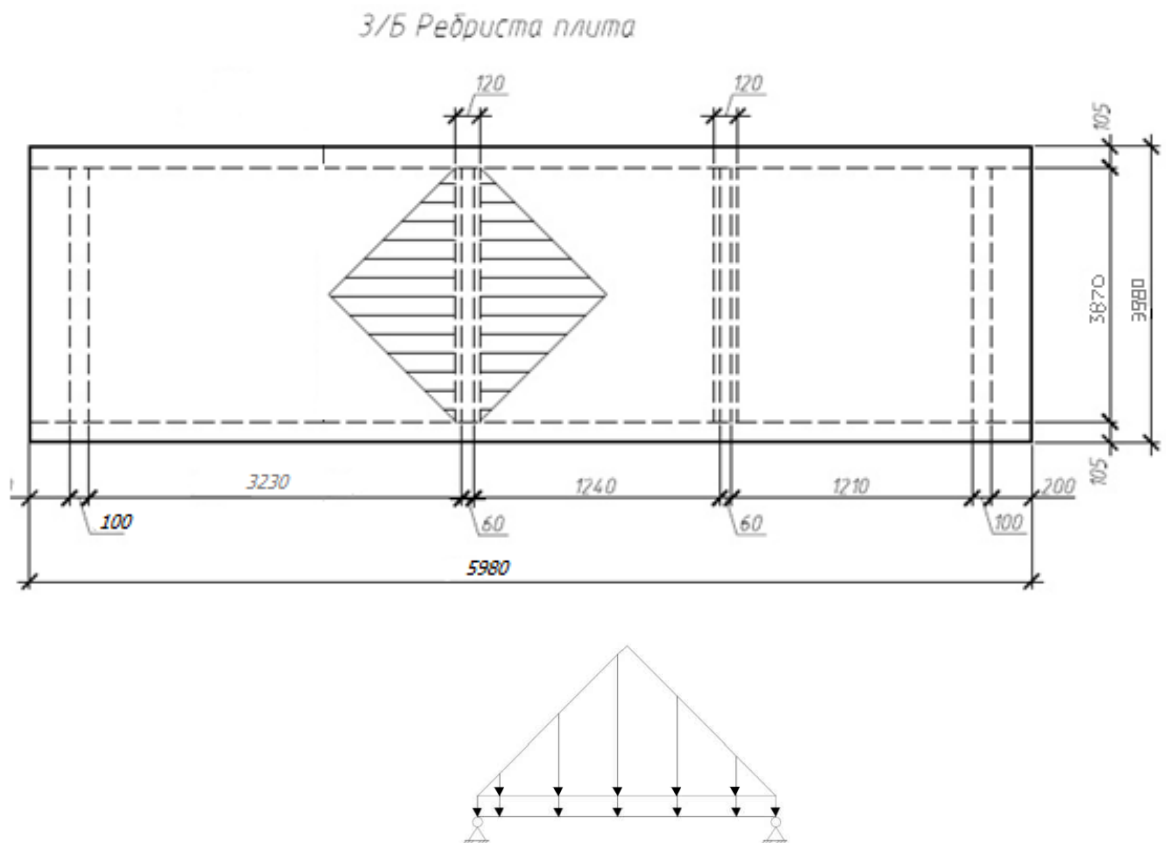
Розрахункова схема поперечного ребра
